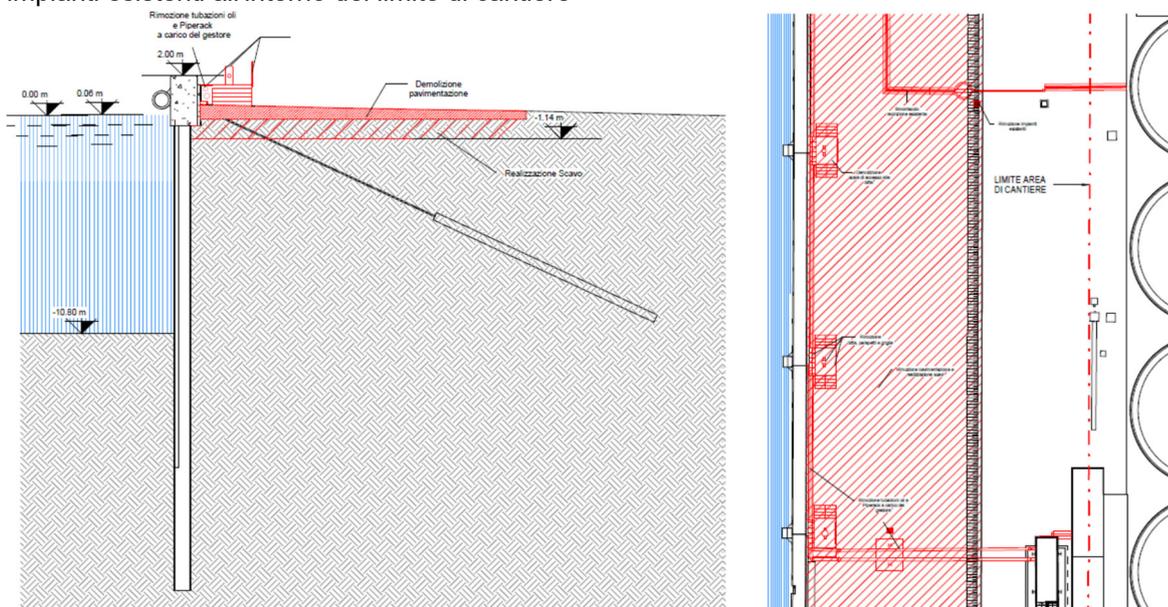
Banchina Bunge Sud – Fase 1 – Sezione e planimetria
